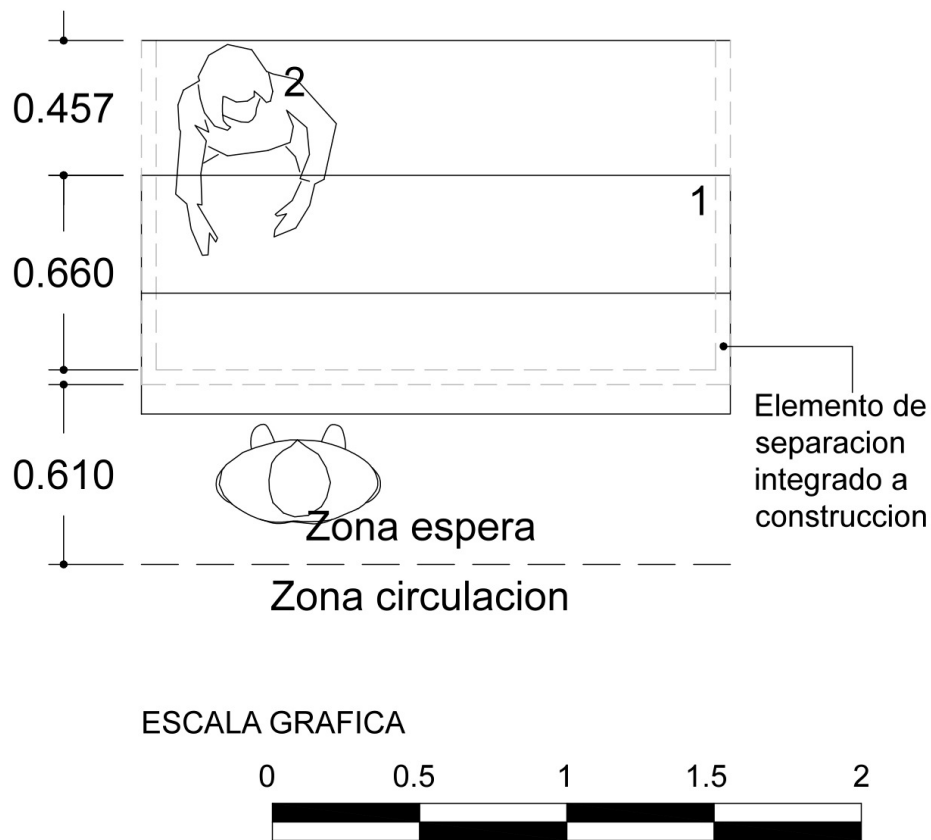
Planta arquitectónica de recepción/control en el área de consulta externa.
